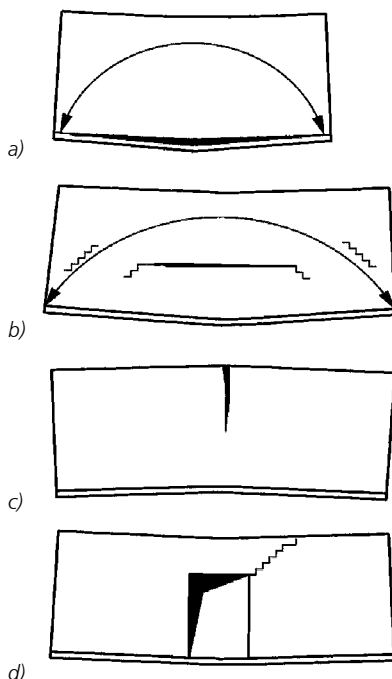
Tragmechanismen und Schadensbilder bei Mauerwerk:
